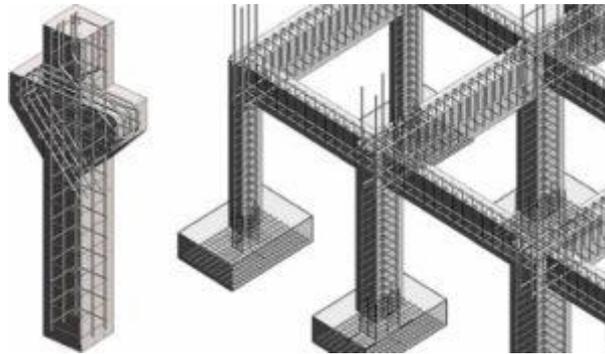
Système Poteau poutre en béton armé¹⁷⁹
